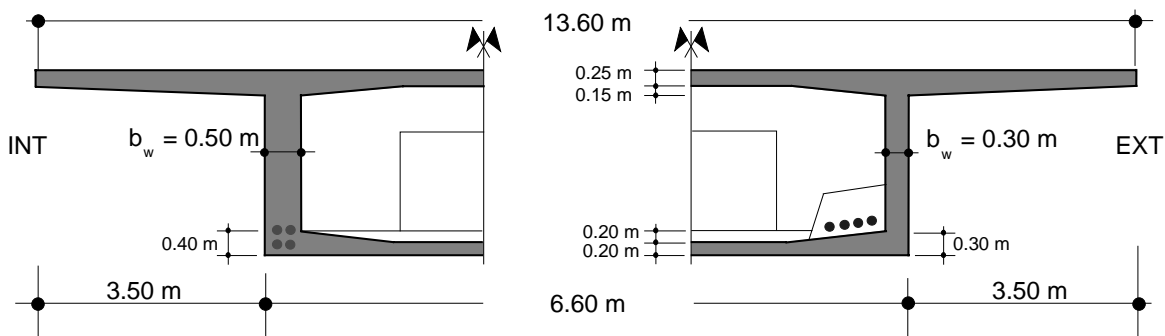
Demi-coupes transversales des poutres précontraintes intérieurement et extérieurement.
